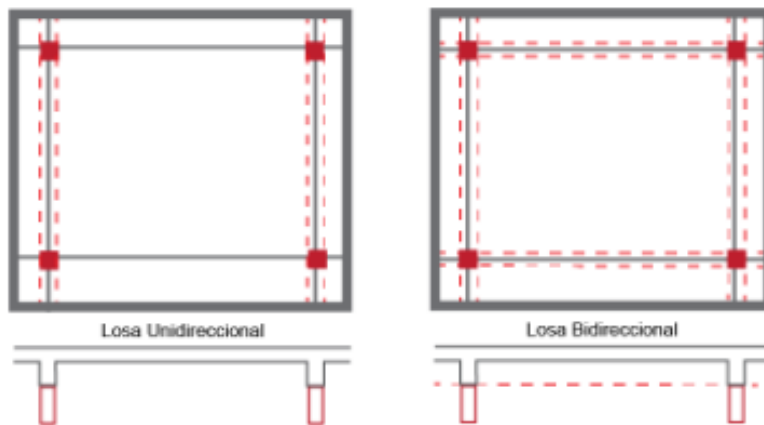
Tipos de Losa según su Distribución de Esfuerzos
